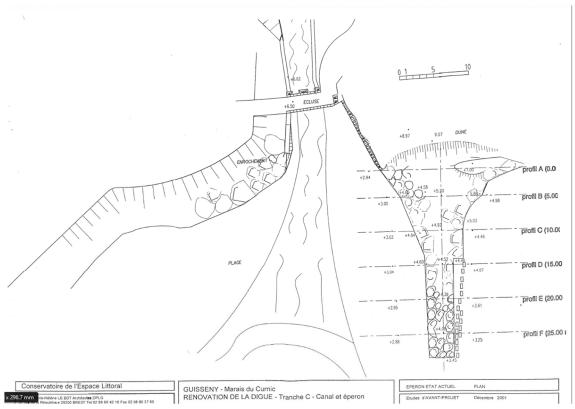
Plans d'avant-projet des travaux de 2001. Source : Mairie de Guissény.
